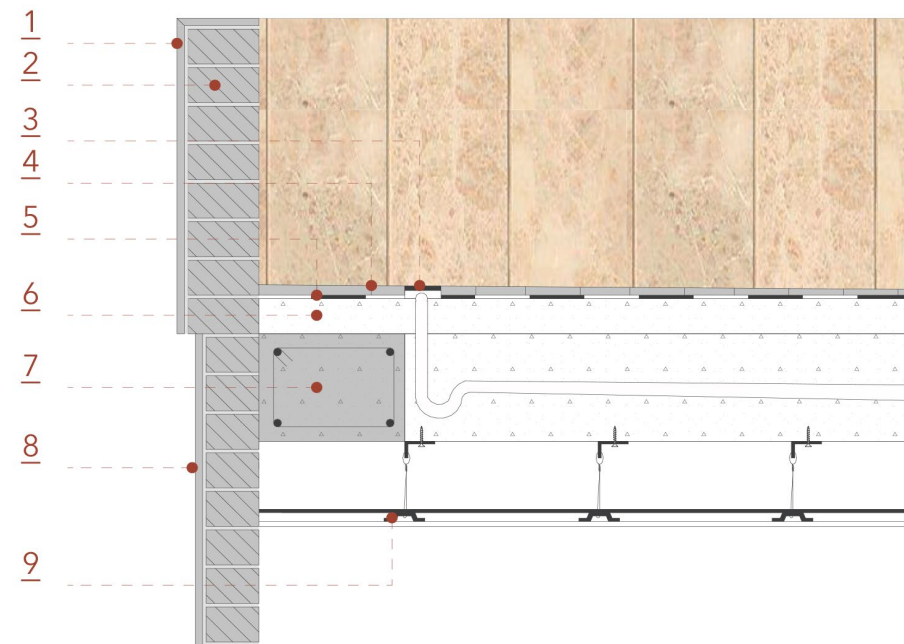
Detalle constructivo de remate superior en fachada de terraza. Gráficos de la autora.
